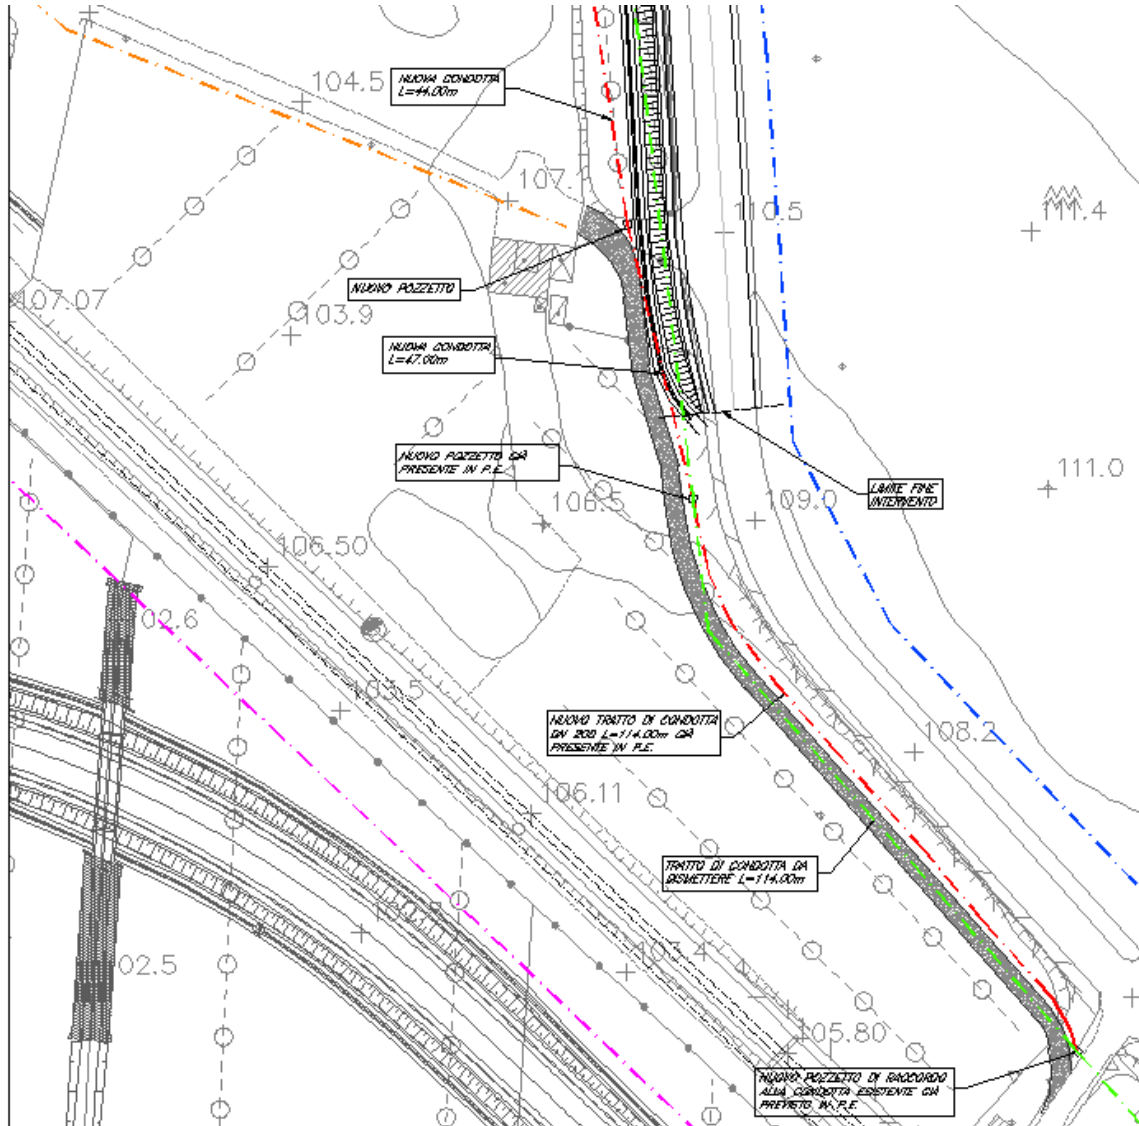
Planimetria risoluzione sottoservizi – tratto sud
